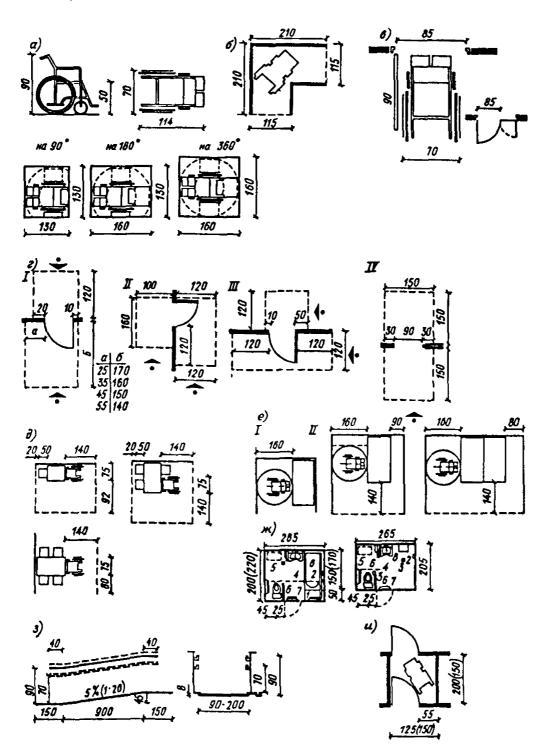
Планировочные требования к помещениям, обеспечивающие передвижение в них инвалидов на креслахколясках
